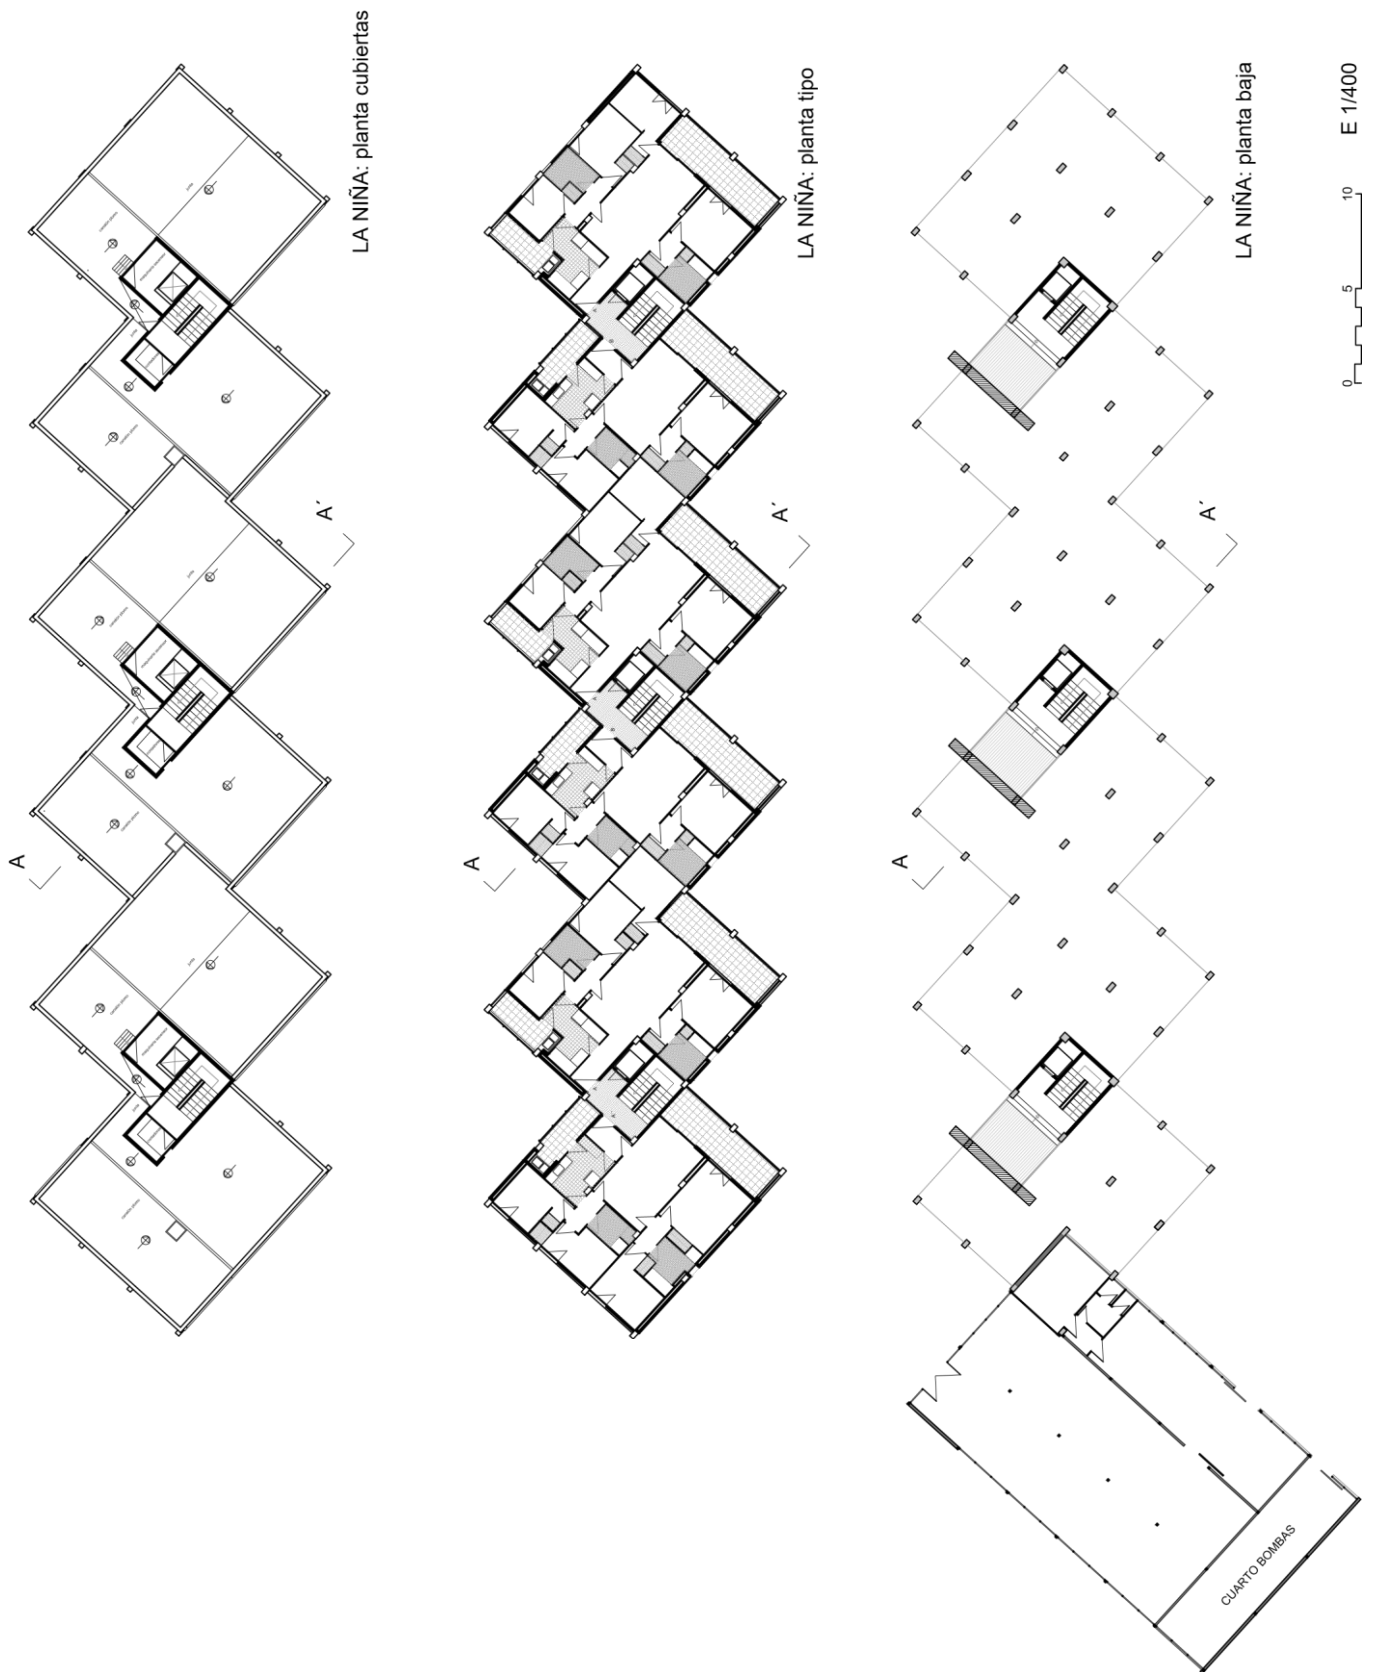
Planos redibujados de la planta baja, planta tipo y planta de cubiertas del bloque La Niña
